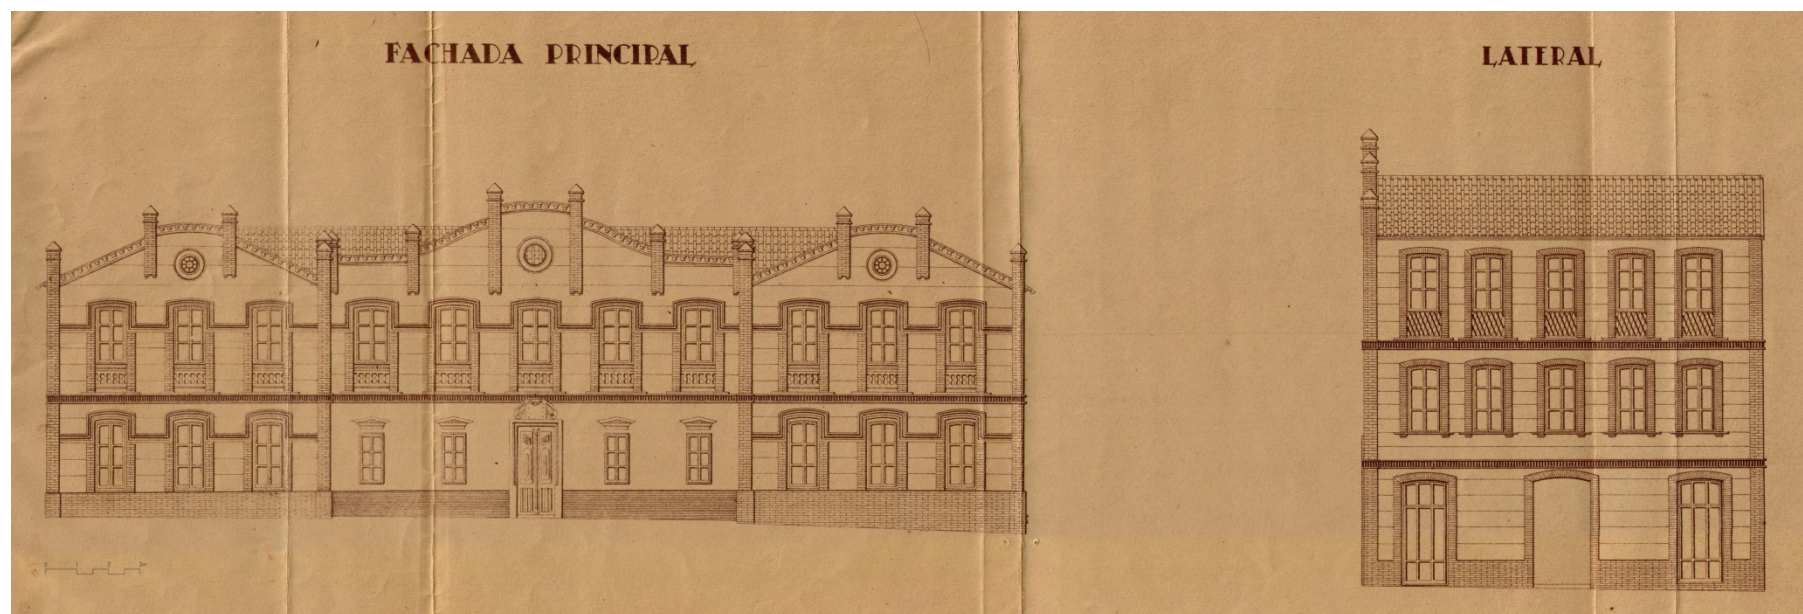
Plano del Proyecto de reforma interior del Pabellón de Hospedería para dotarlo de un comedor y terraza exterior hacia el valle. Arquitecto Juan Vidal Ramos. Año 1933.<sup>172</sup>
